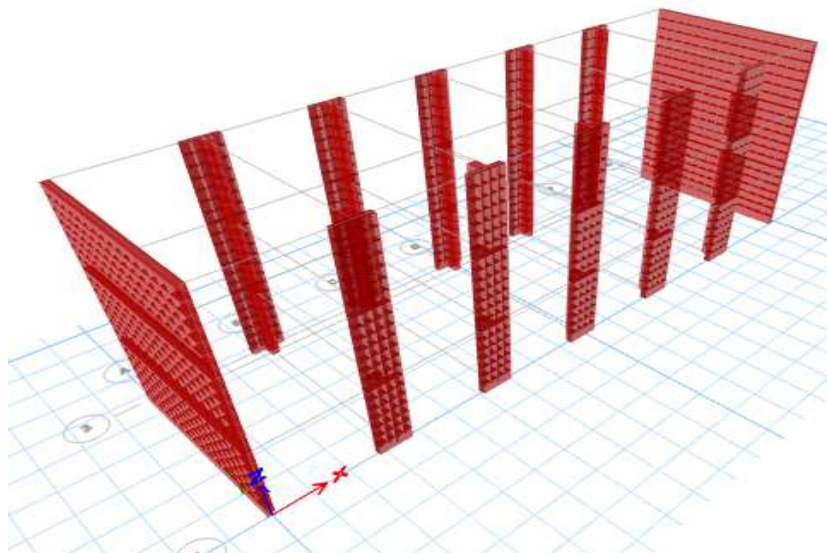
Vista 3D modelado Placas y Muro de albañilería
